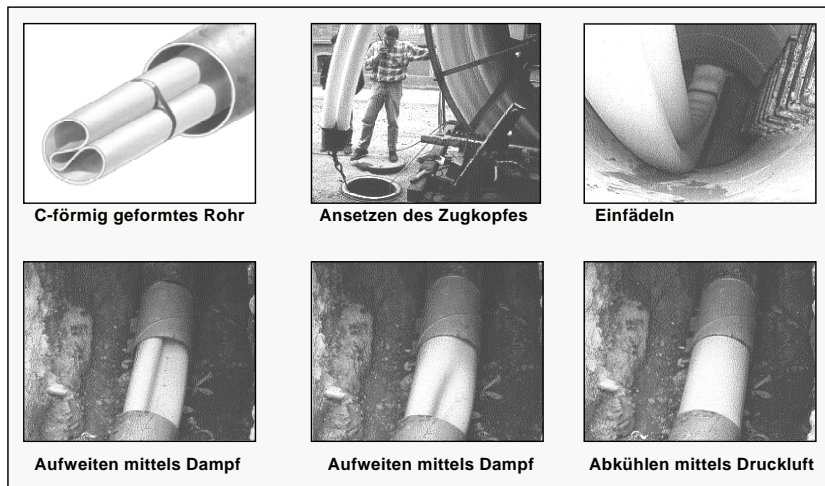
Detailansichten des des Langrohr-Relinings [1,8]
